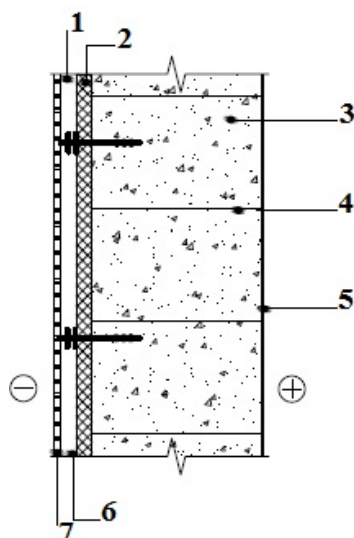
Стеновой блок «вентилируемый фасад (облицовка с утеплением)»: 1— система крепления фасада (условно не показана); 2 – минераловатная плита (толщина по проекту); 3 — блоки YTONG; 4 — раствор для тонкошовной кладки YTONG; 5 — внутренняя отделка; 6 — воздушный зазор от 40 мм; 7 — навесной фасад (сайдинг, керамогранит, композитные панели и пр.)
